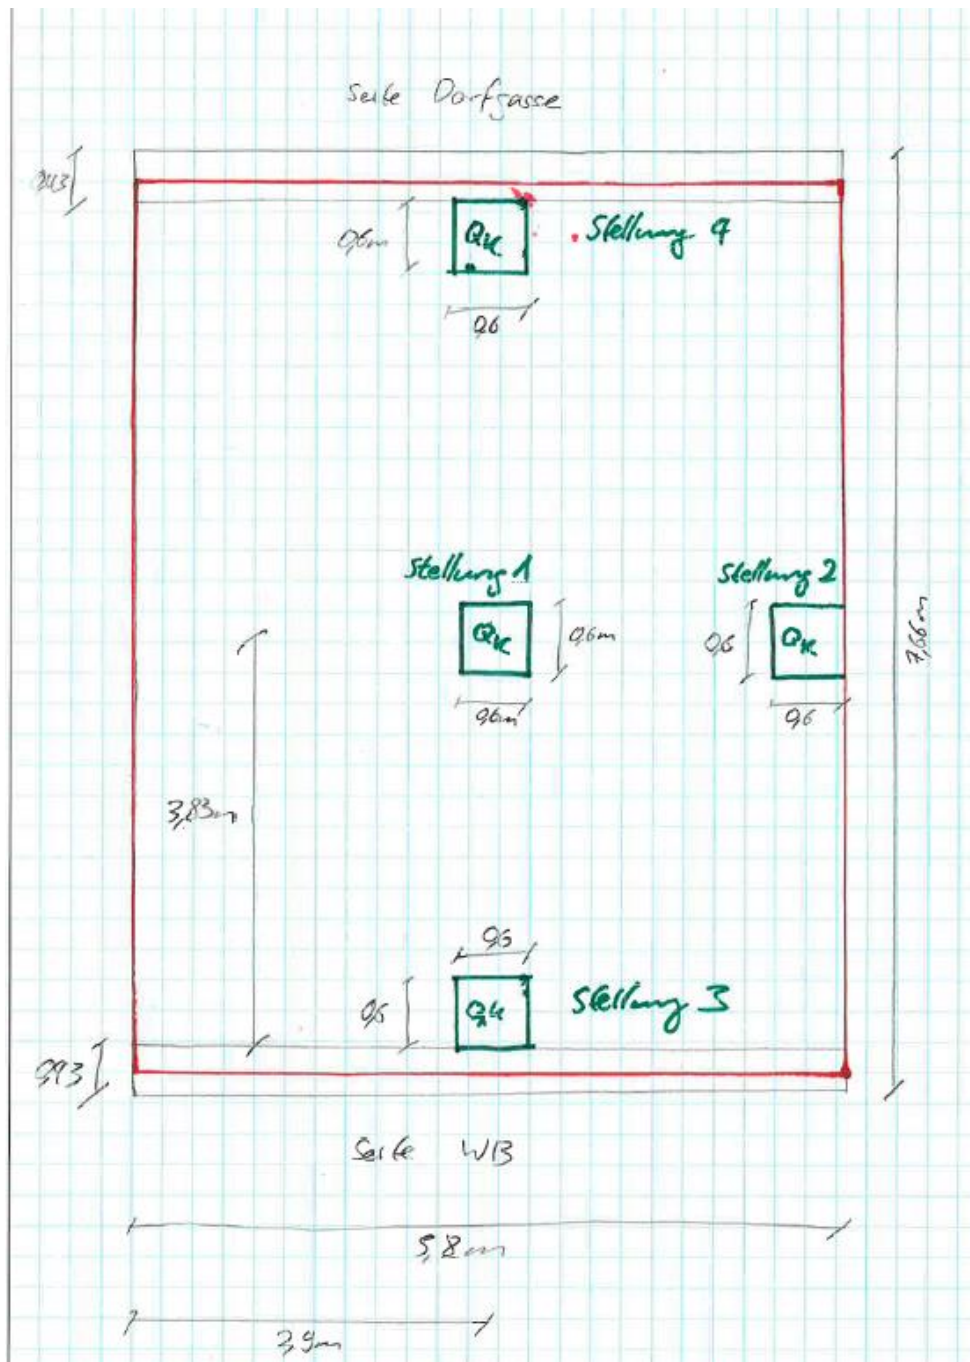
Die massgebenden Laststellungen von Lastmodell 2 im Grundriss dargestellt
